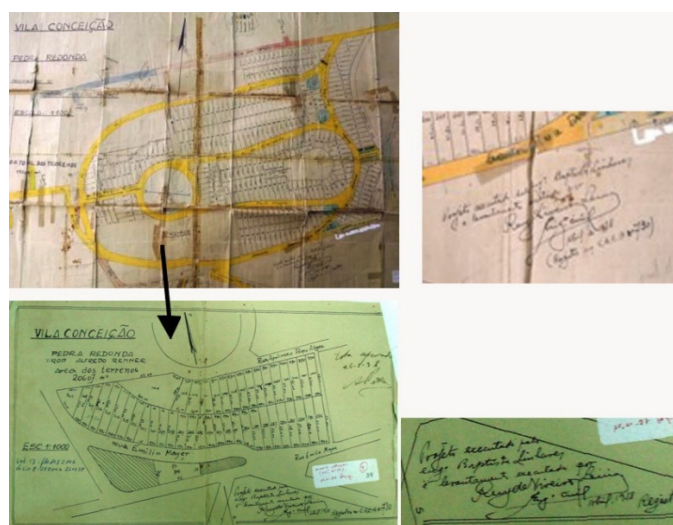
Planta do loteamento da primeira parte da Vila Conceição, autoria do Engenheiro Baptista Linhares. Consta assinatura do Engº Ruy de Viveiros Leiria como responsável pela execução do levantamento cadastral da área de propriedade de Alfredo Renner, em abril de 1938.
